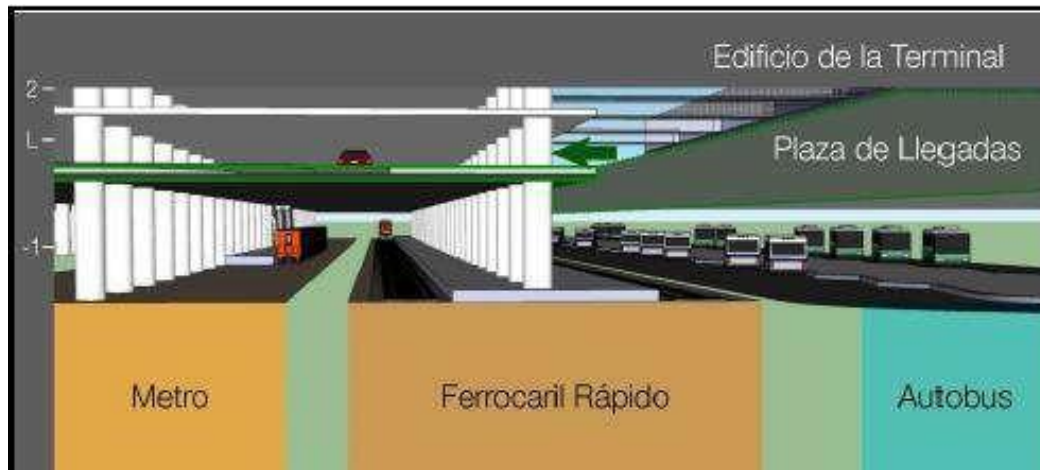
Centro de Transporte Terrestre (sección) NAICM
